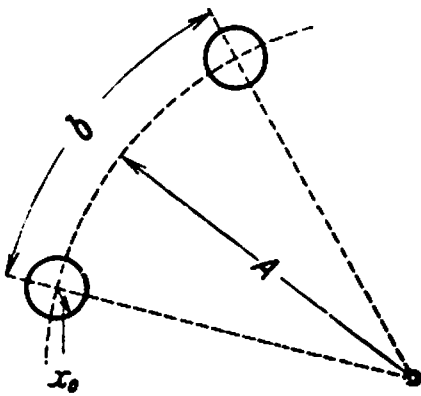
Mehrbrunnenanlage von kreisförmigem Grundriß mit einer Brunnenstaffel.
